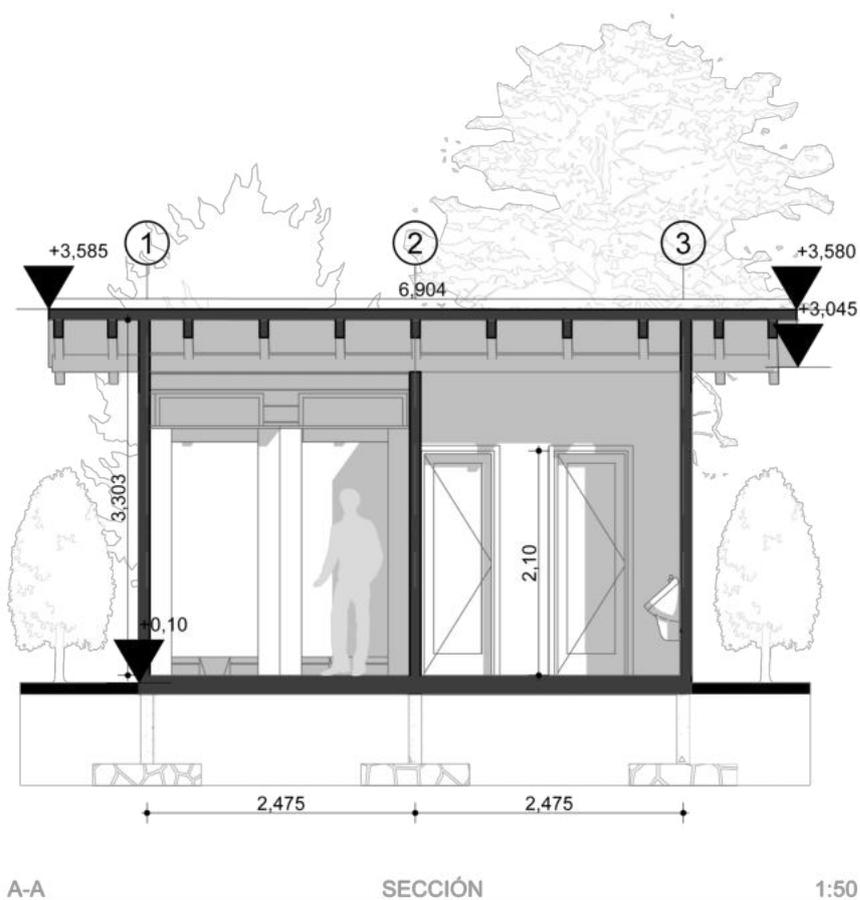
Plano 2–Sección A-A de baterías sanitarias. Fuente: Elaboración propia Nota: Sección de Baterías sanitarias
